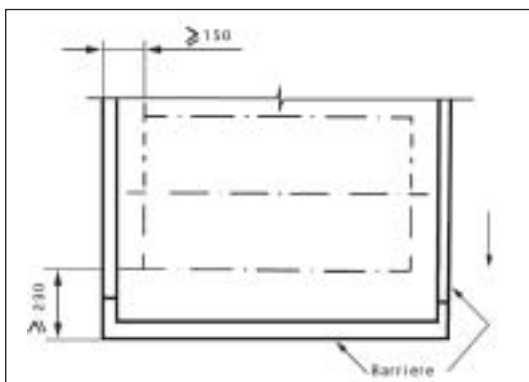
Proiezione su piano orizzontale dei dispositivi di protezione (dimensioni in mm).
